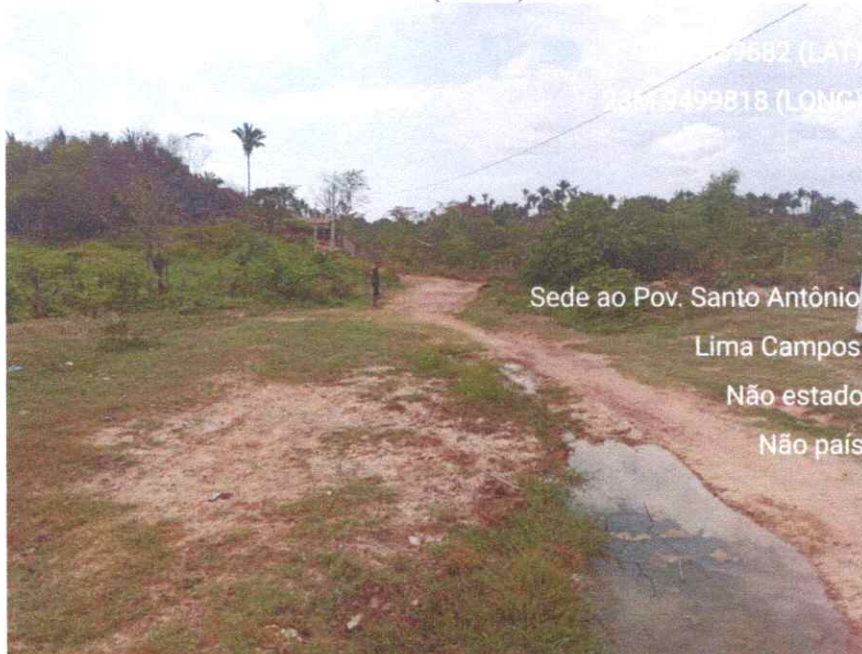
IMPLANTAÇÃO DE BUEIRO
